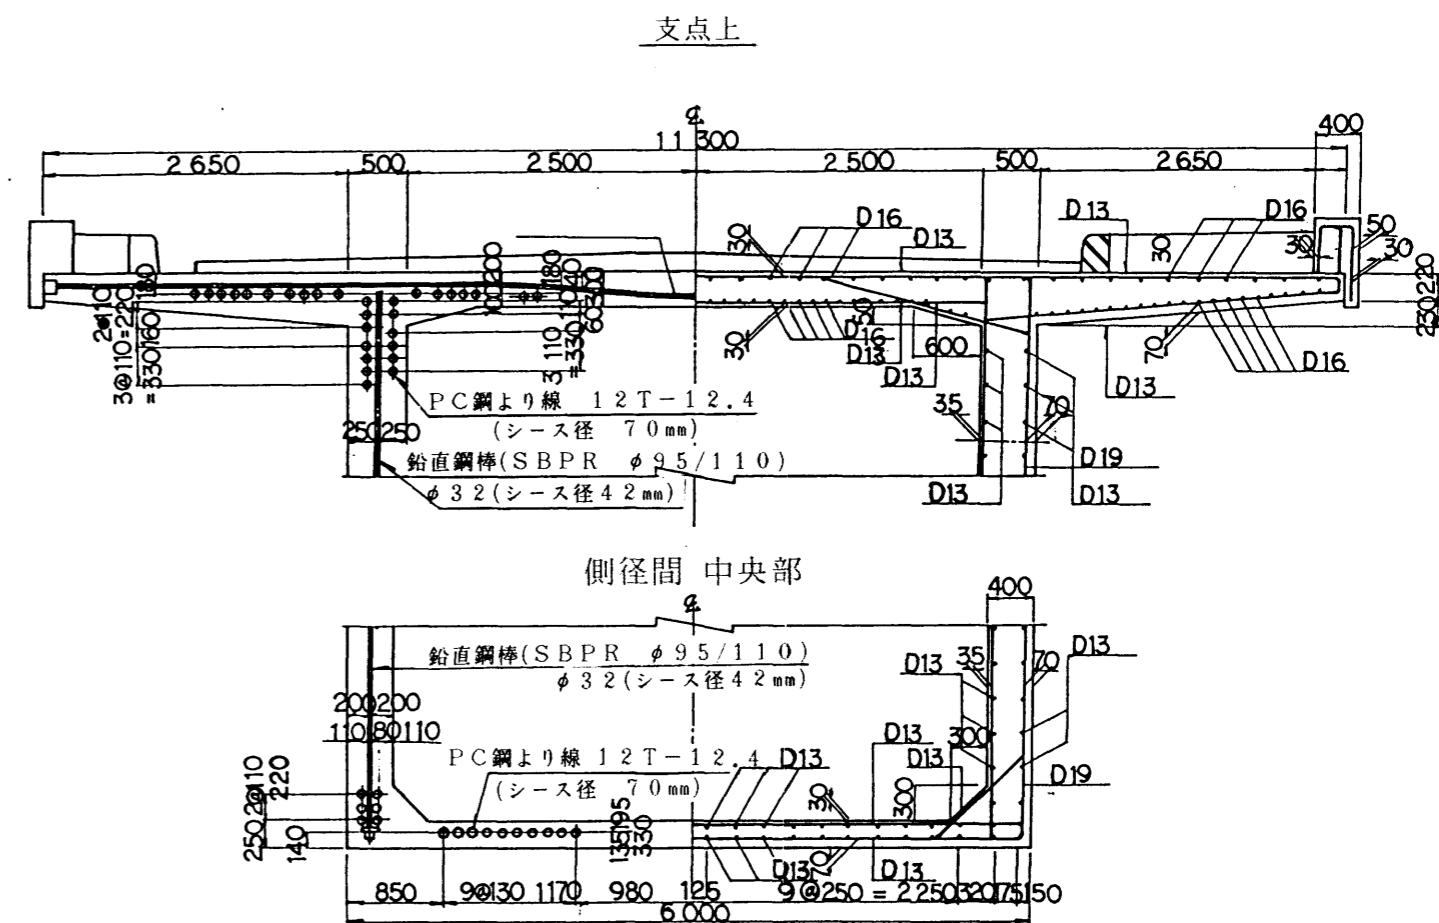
標準断面 PC 鋼材・鉄筋配置図
